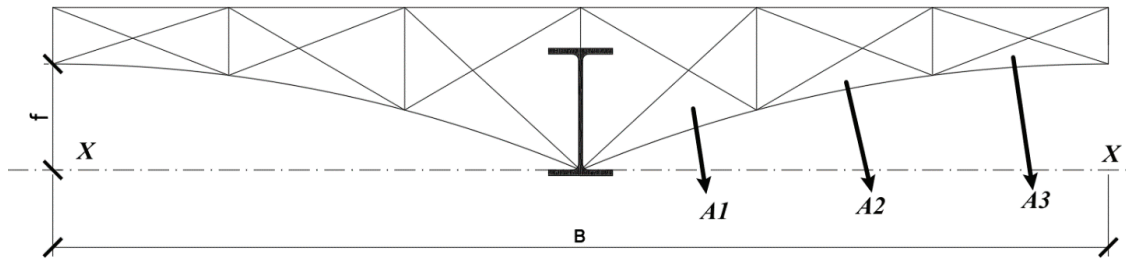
Отдельная схема расчета, где A1, A2, A3 — площадь
